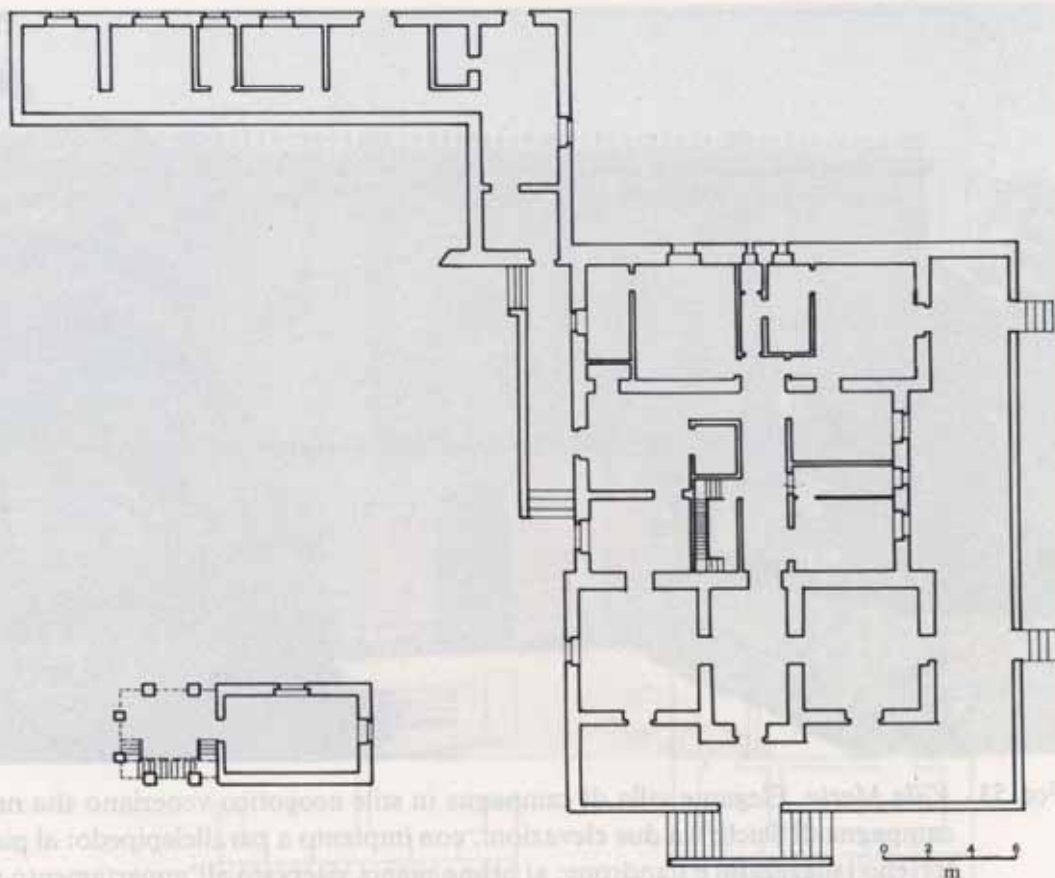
Villa Galfo*. Rilievo planimetrico.
